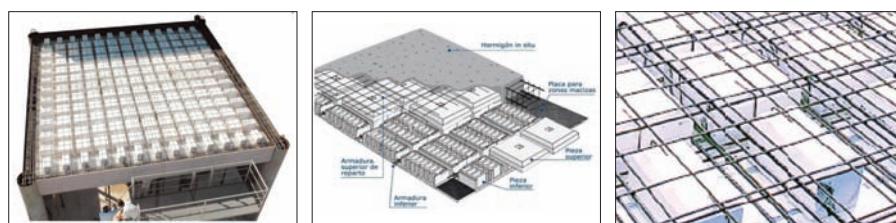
Detalii constructive planșee SOLAIO CUBE
